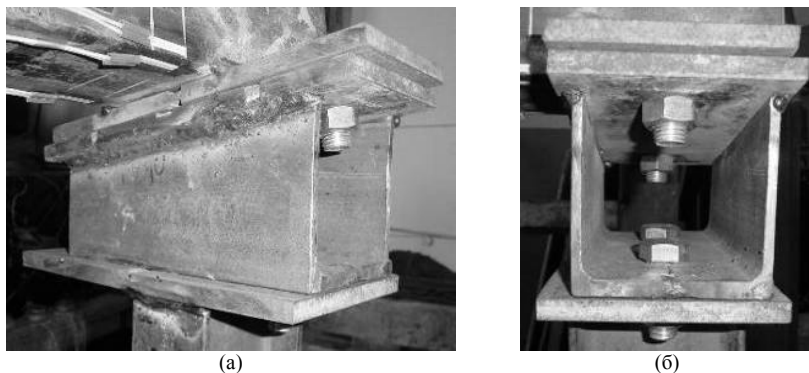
Конструкція „башмаків” (а) – вигляд збоку; (б) – вигляд спереду
